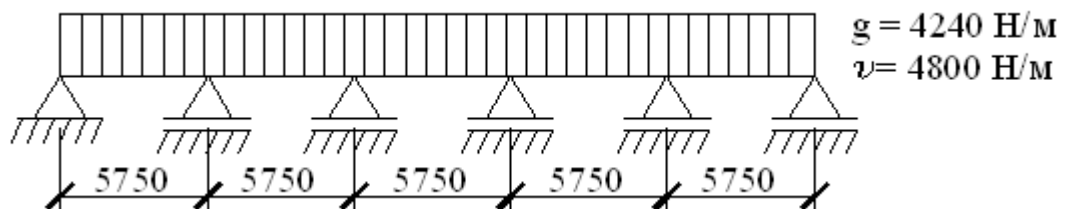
Розрахункова схема плити в напрямі  $l_1$
